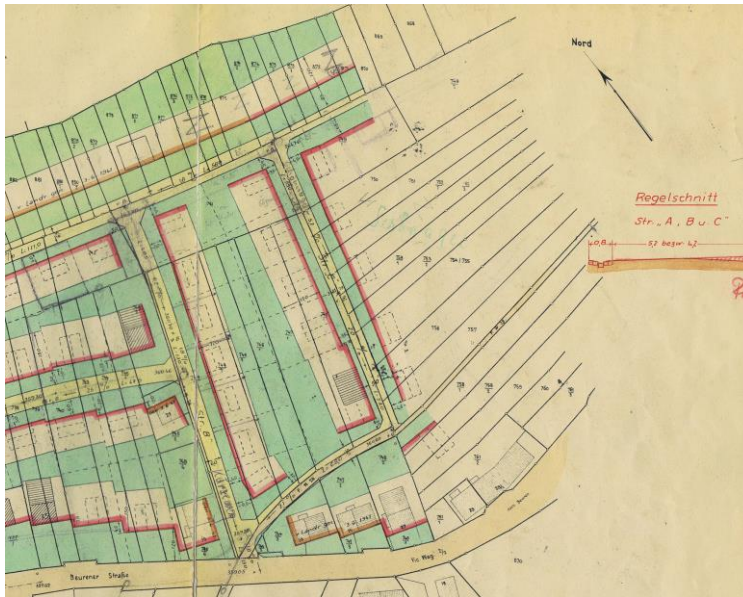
Auszug aus dem Baulinienplan (unmaßstäblich)
